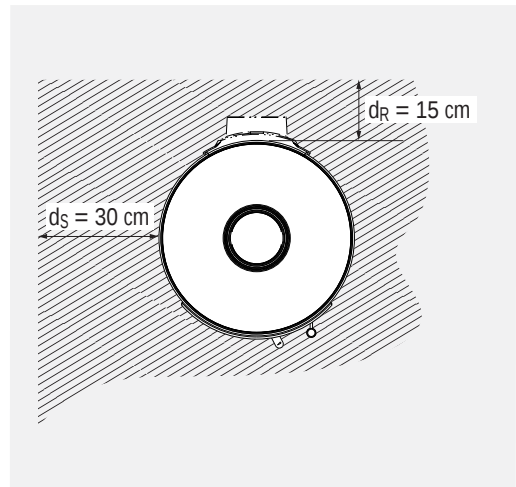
Mindestabstände zu brennbaren Baustoffen oder Bauteilen bei COLONA
